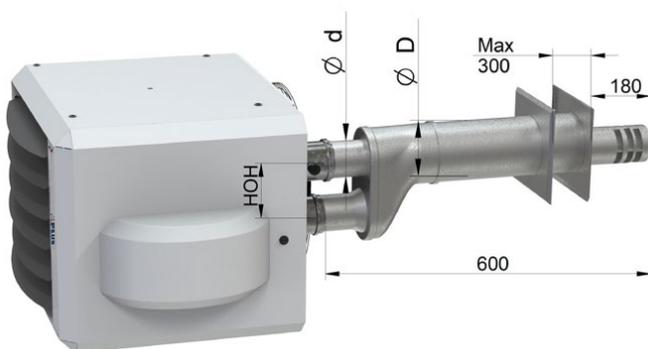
Terminal horizontal des produits de combustion AG M D
